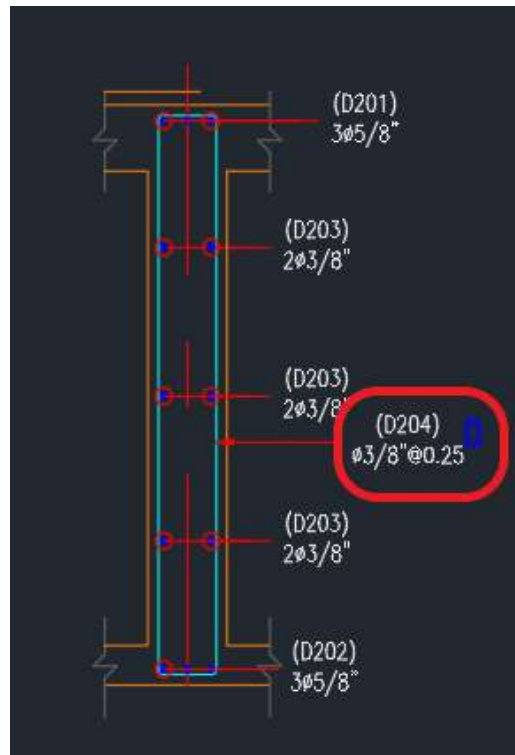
Vista del detalle SECCIÓN 2-2 del plano EST-O2-PT-05-09-r0
